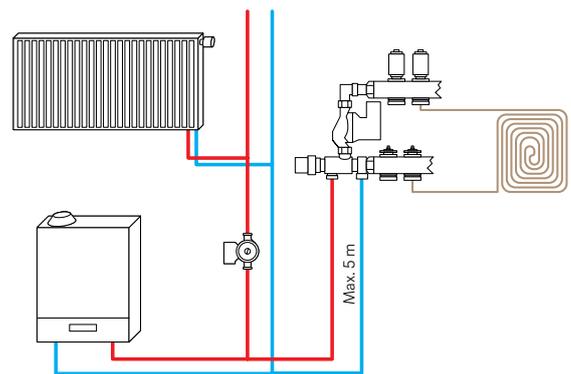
Anschlusschema mit externer primärer Umwälzpumpe
